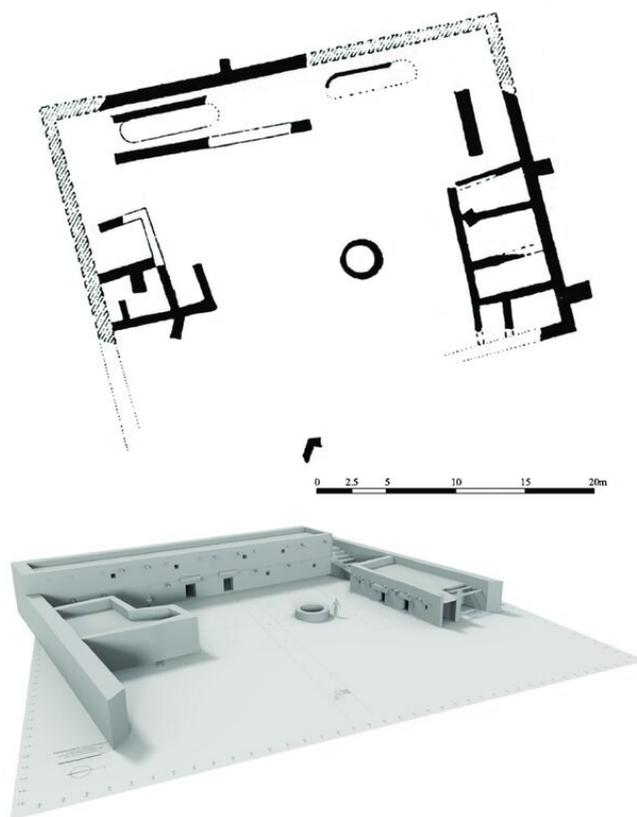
Planta del sector excavado del asentamiento rural de Cerro Naranja (según González 1987), y propuesta de reconstrucción de su alzado (elaborada por F. J. Luengo).
